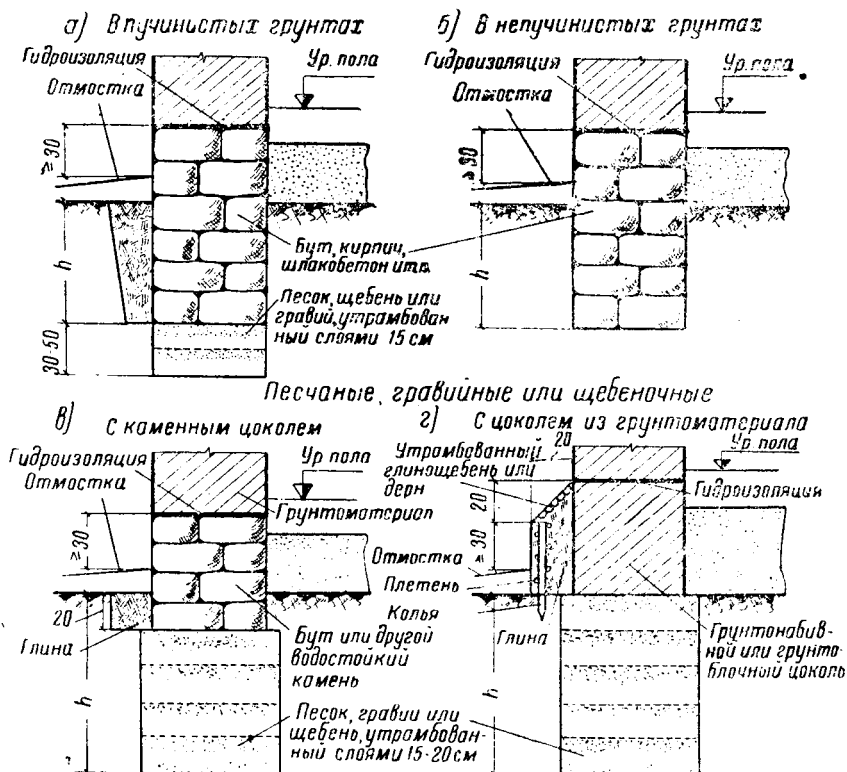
Фундаменты под грунтоблочные и грунтонабивные стены
